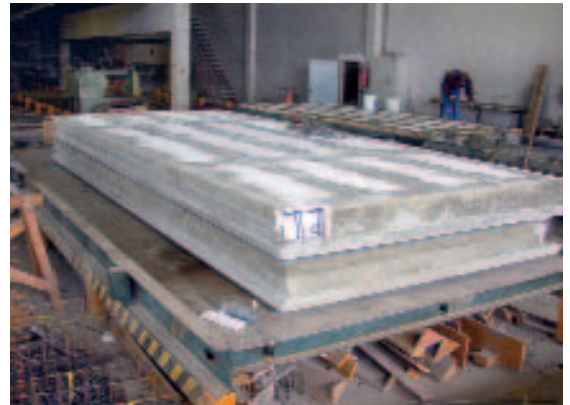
ЭЗаконченная плита перекрытия с установленными блоками из бетона ААС.
